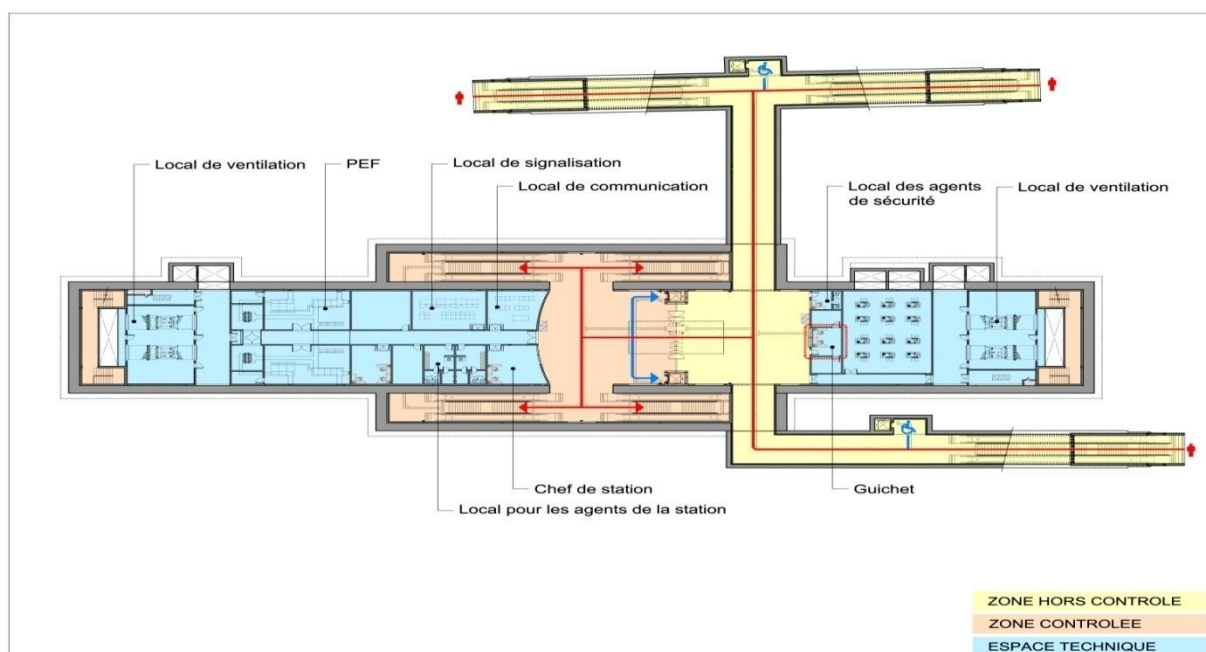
Plan des différentes zones du niveau-1 de la station
